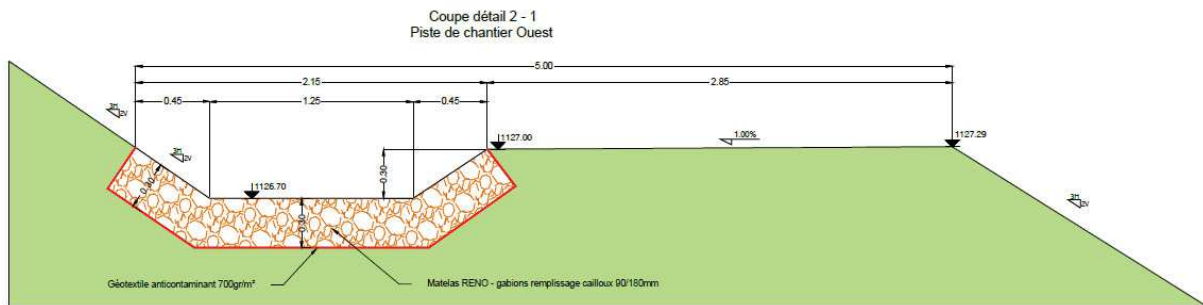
Coupe type des ouvrages trapézoïdaux des descentes Est et Ouest du site (ALLTI, juin 2021)
